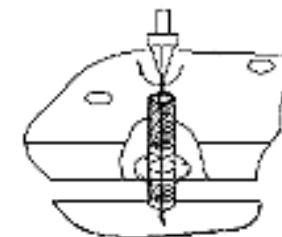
Вкручиваются болты-стойки во втулку основанием вниз. Устанавливается конструкция на перекрытие
